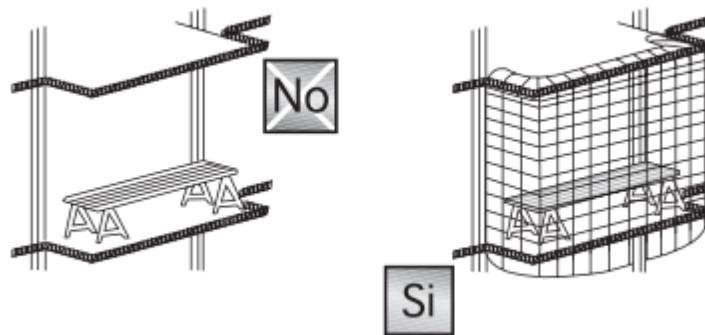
Trabajo con barandillas a más de 2m. Fuente: Nota Técnica trabajos en alturas, protección.
